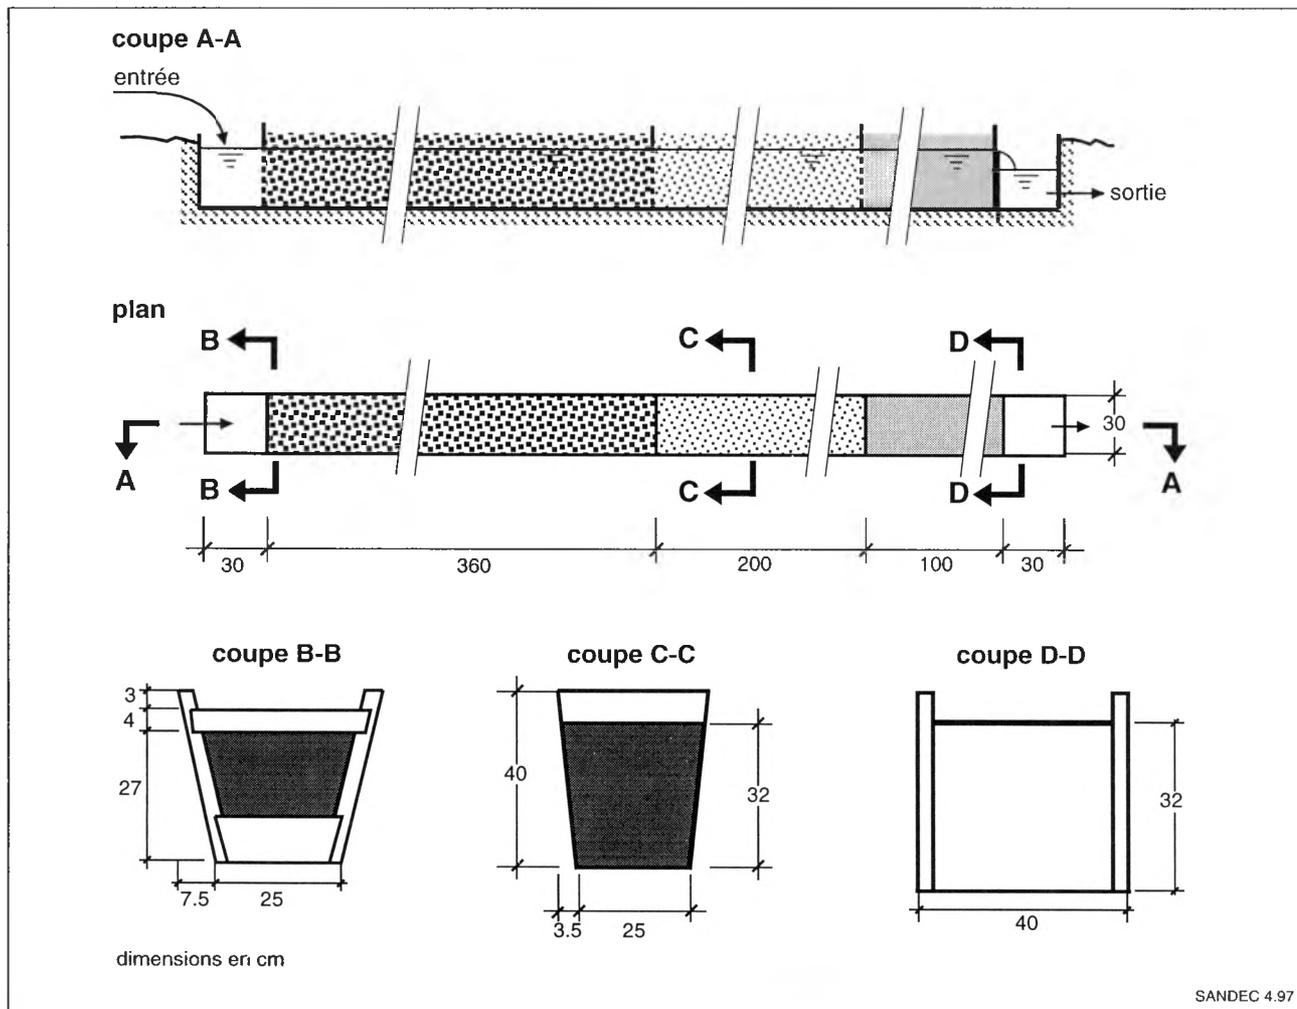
/3 Exemple d'une installation pilote à tranchée pour un préfiltre à gravier à flux horizontal
